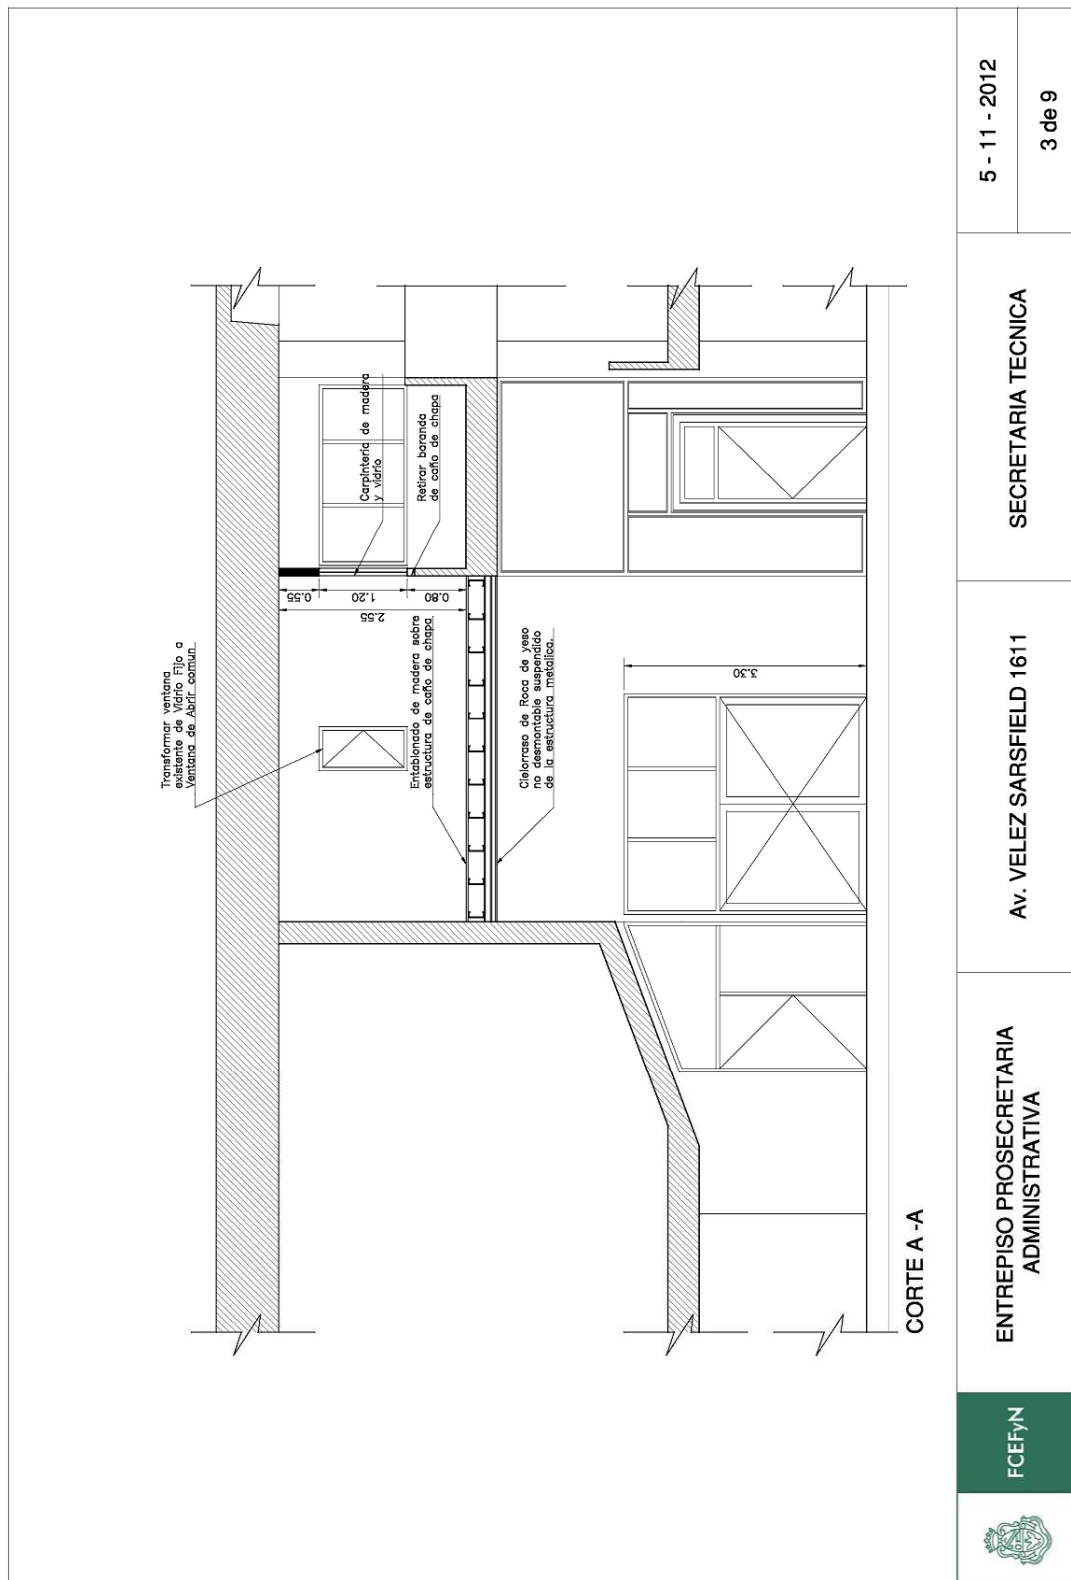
Plano 2 – Fuente: Digitalización de planos originales
